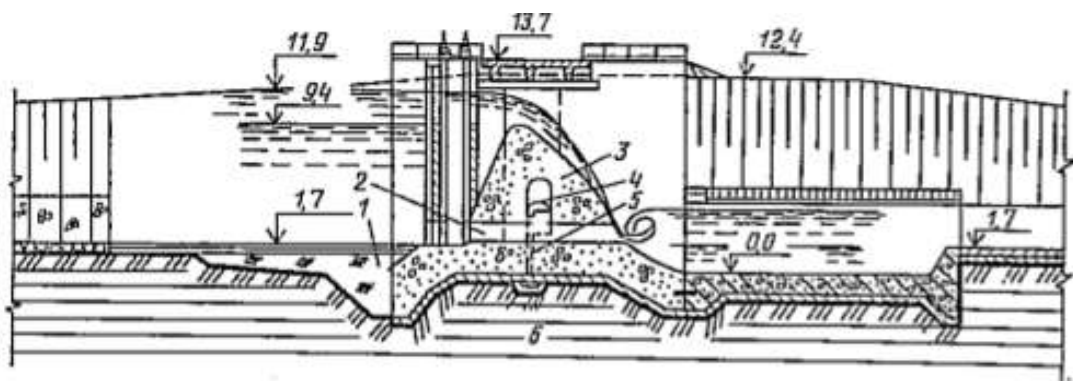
Поперечное сечение водосливной бетонной плотины, устроенной при реконструкции в головной части быстротока Черненского водохранилища [23]: 1 – понур; 2 – донный водовыпуск; 3 – водослив; 4 – смотровая галерея; 5 – пьезометр; 6 – аргиллитоподобные глины
